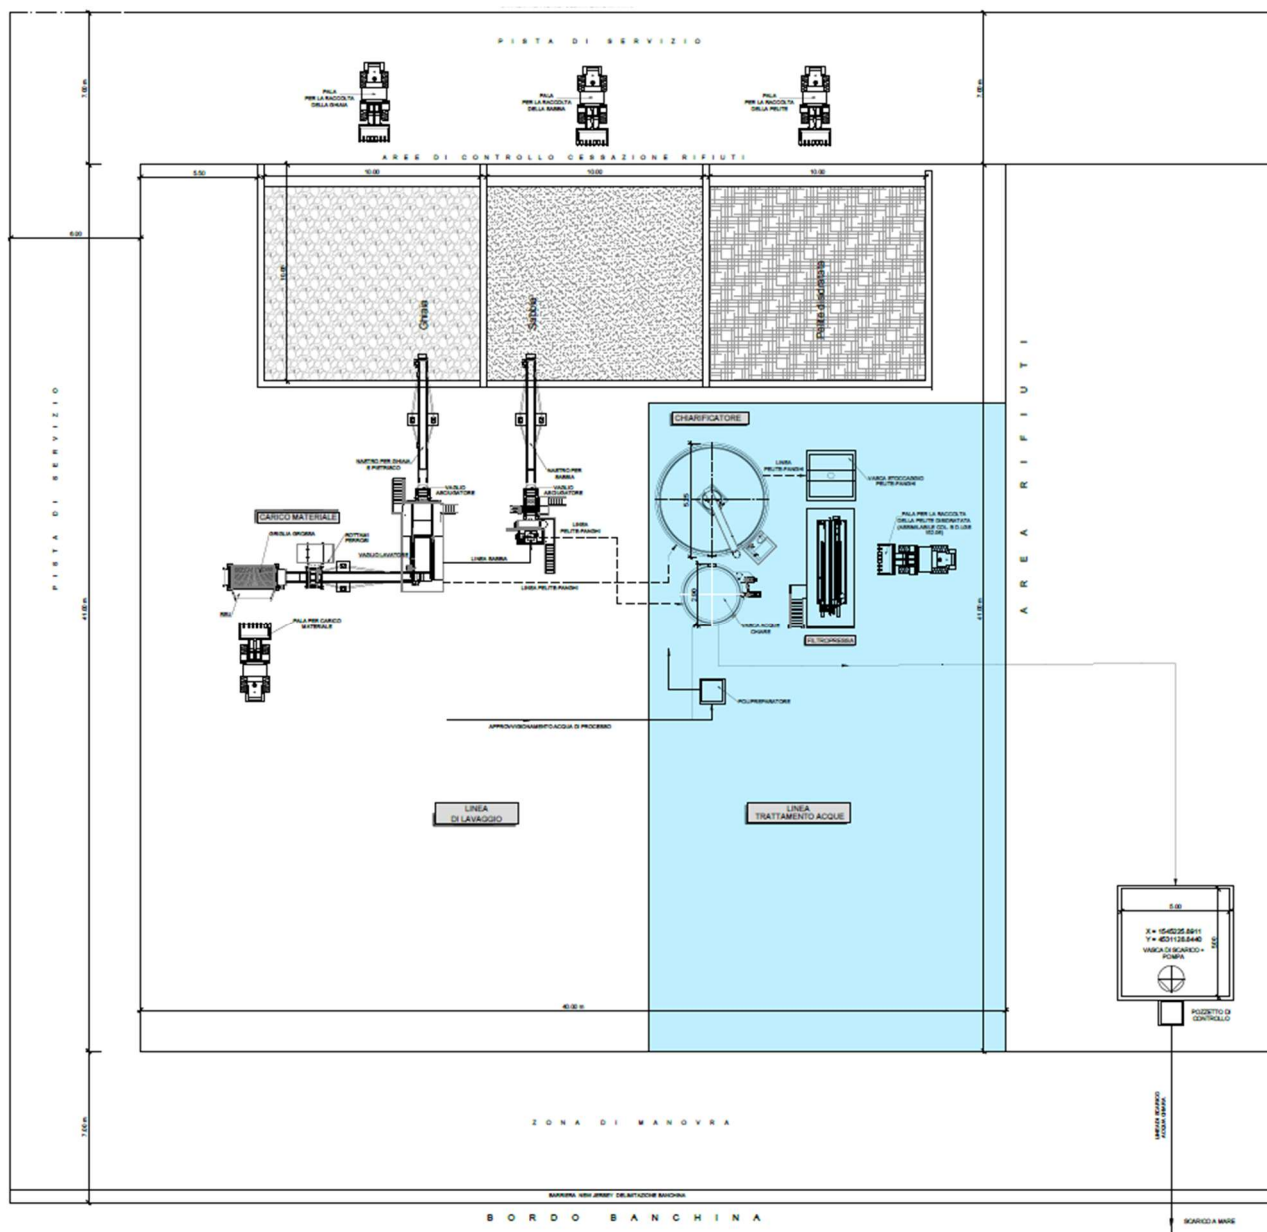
Lay-out in pianta dell'impianto soil washing (fonte: diemmesoilwashing.s.r.l.) Per una migliore lettura di rimanda alla tavola PFTE-DS6.01.38
